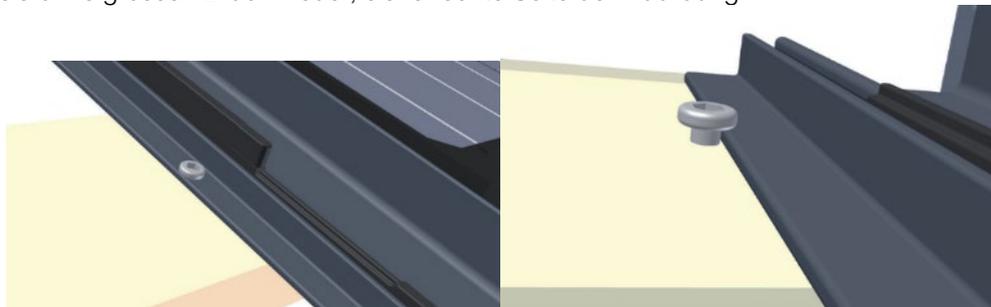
Befestigung Mitte, Fixierung seitlich
